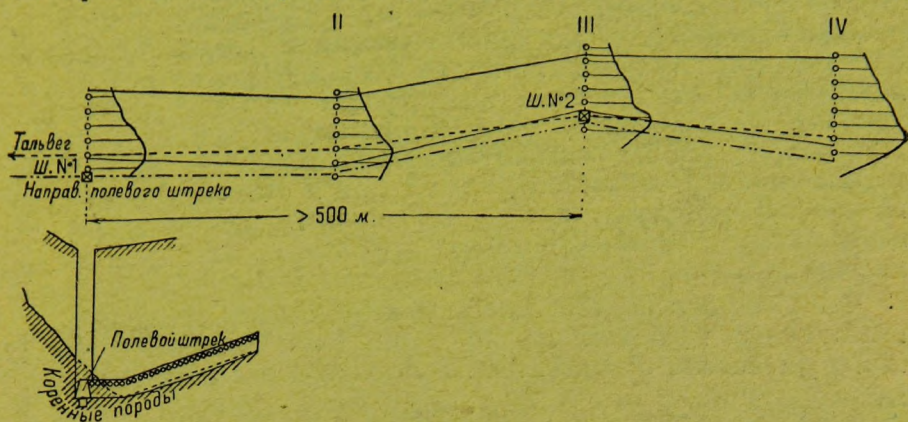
а и б. Схема вскрытия центральными шахтами (план и продольный разрез).
